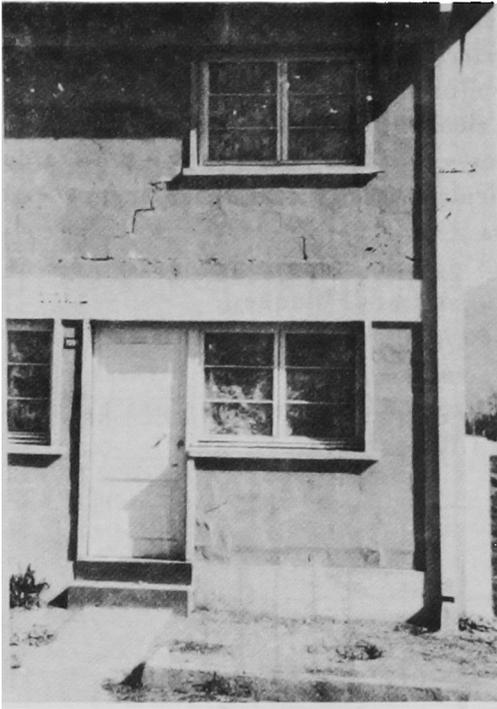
Grietas producidas por el terremoto en un muro de fachada. Población Pedro Aguirre Cerda, San Felipe.
